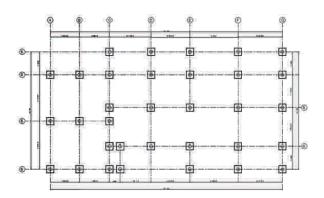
44 : Plano de fundación aislada con pilotes de rollizos de madera de diámetro de 8" a 10", disposición de los cimientos según los ejes respectivos.
